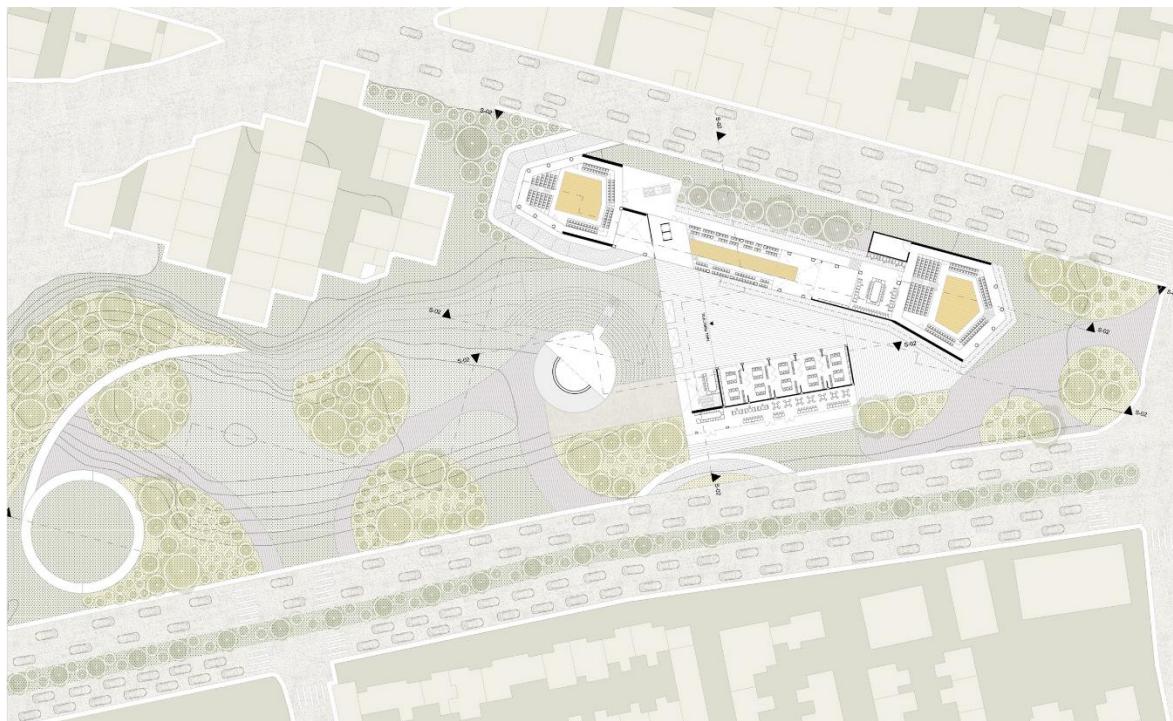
Planta Baja*. Fuente: Elaboración propia.
